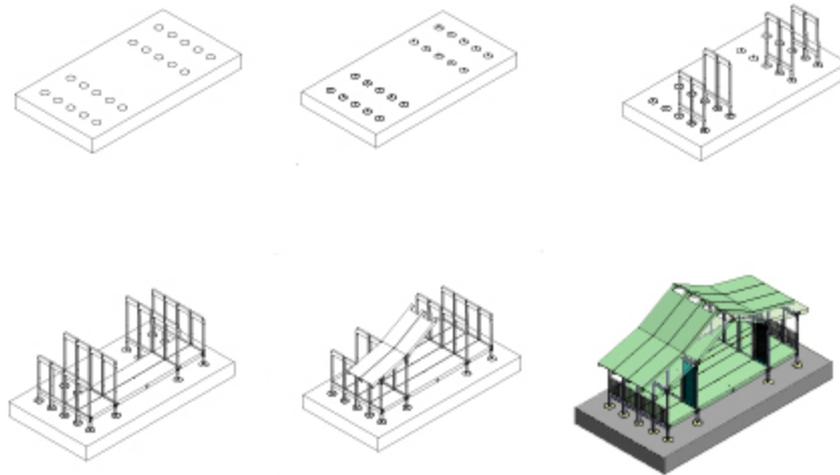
Etapas de construção da casa, planejadas com modelagem 3D
